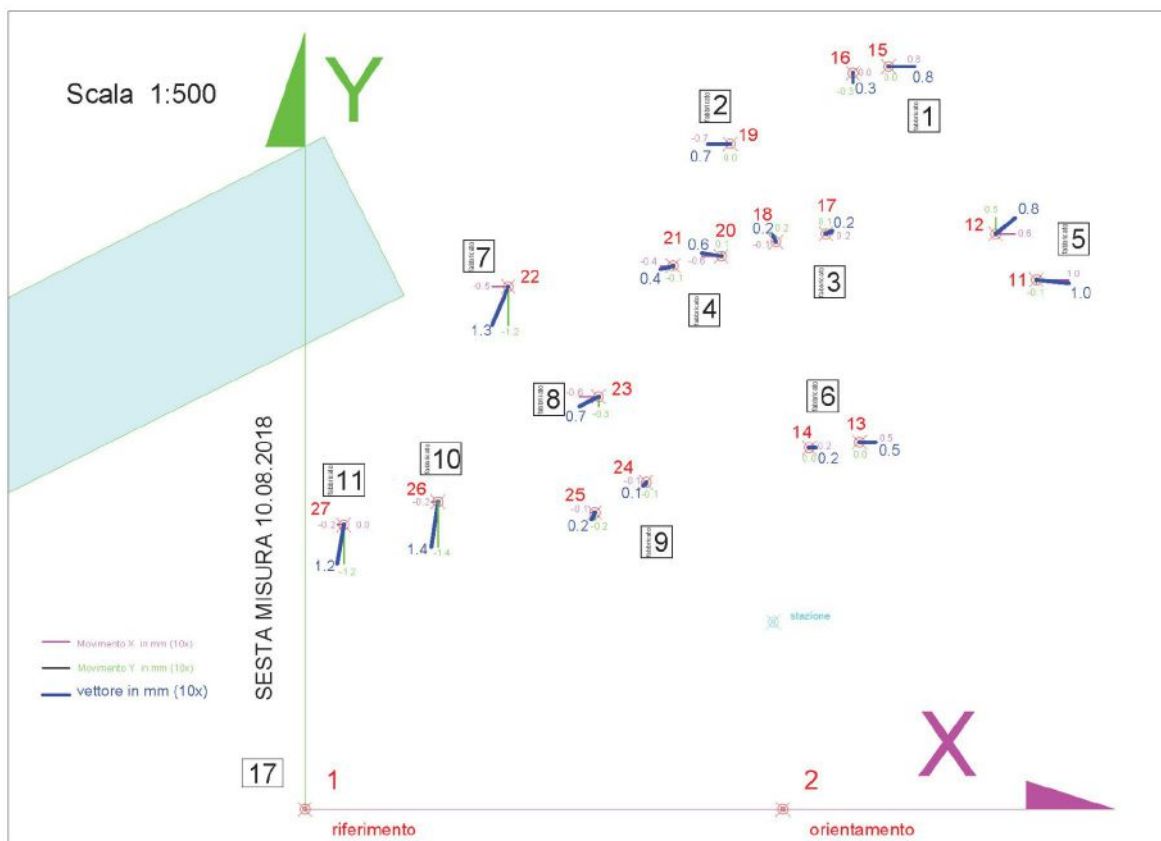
Pianta degli spostamenti rilevati su ciascuna abitazione (misura 6 del 10 agosto 2018).
